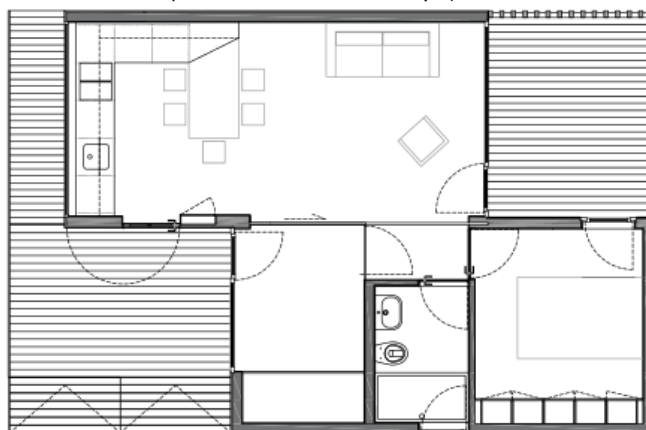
Planta *Treehouse* Riga T1+1 s/escala, JULAR.
